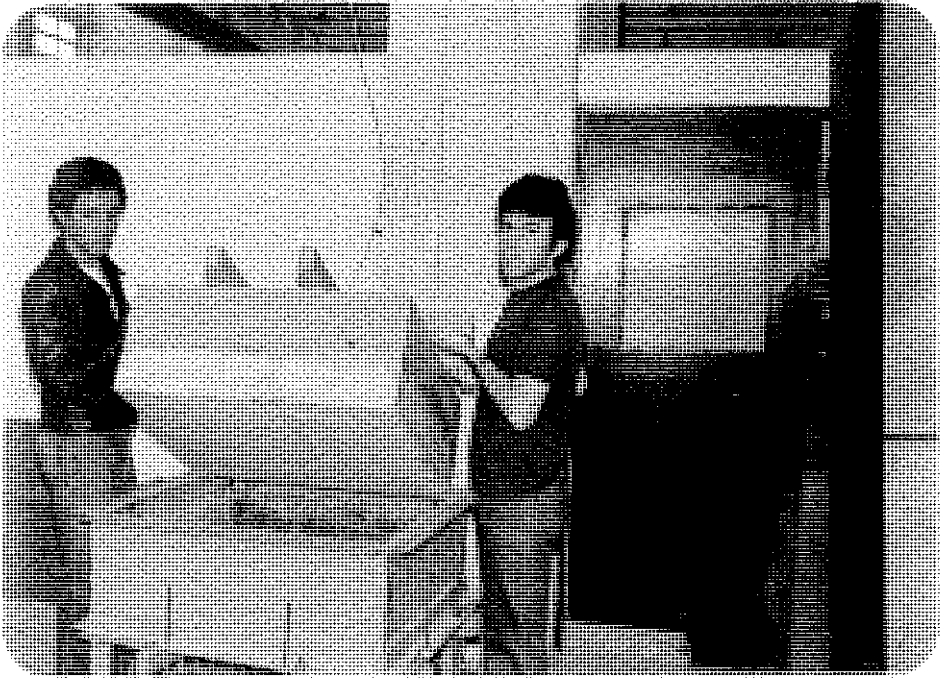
Vista do início de um teste, com aplicação de carga observando a colocação da estrutura de aplicação do carregamento.
